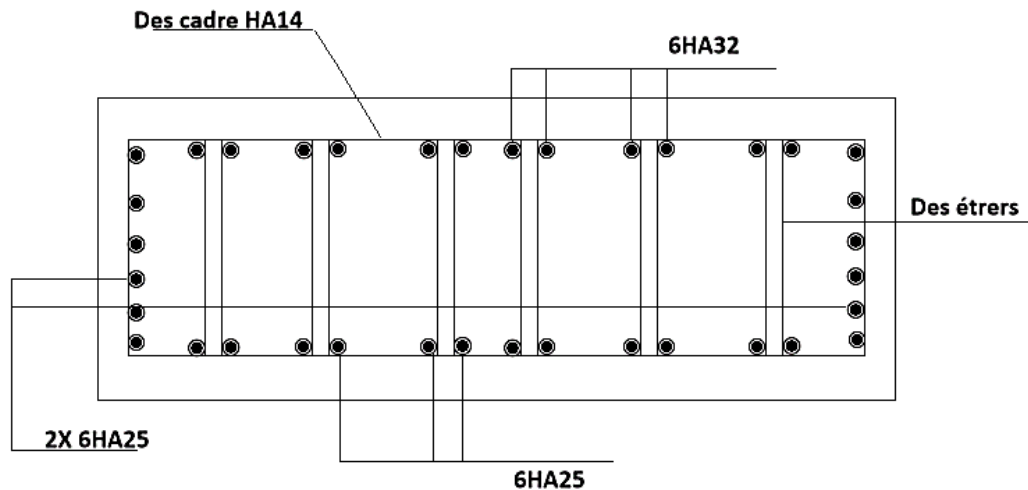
FERRAILLAGE TRANSVERSAL DU CHEVETRE
